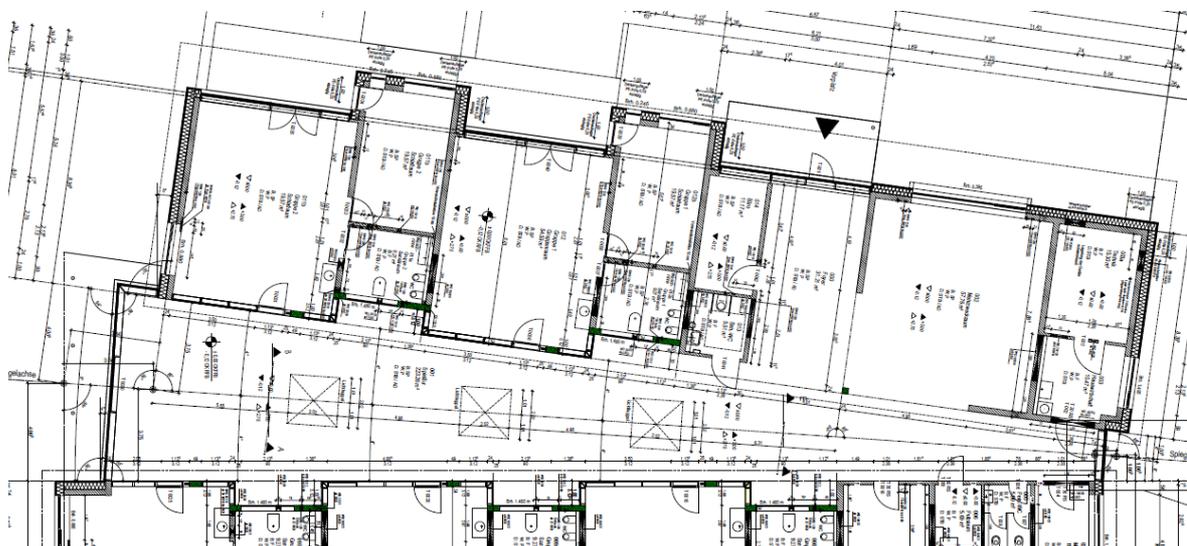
Auszug aus Grundriss westlicher Gebäudeteil
